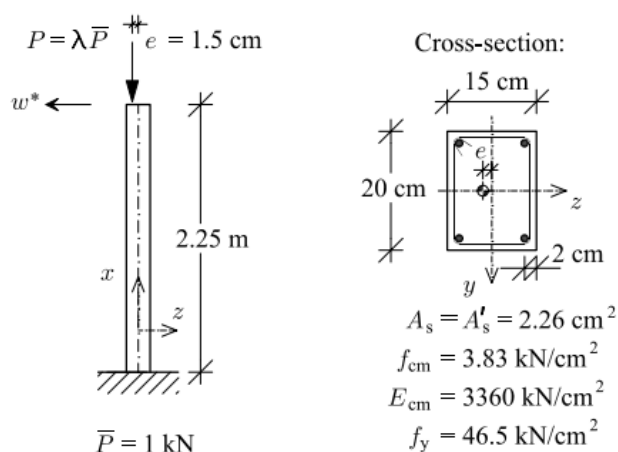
Pilar de concreto armado com carga excêntrica – Exemplo 2
